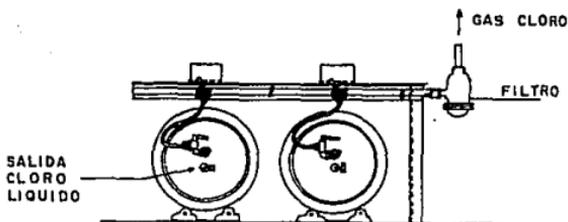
TANQUES CONECTADOS PARA REMOVER GAS CLORO.
